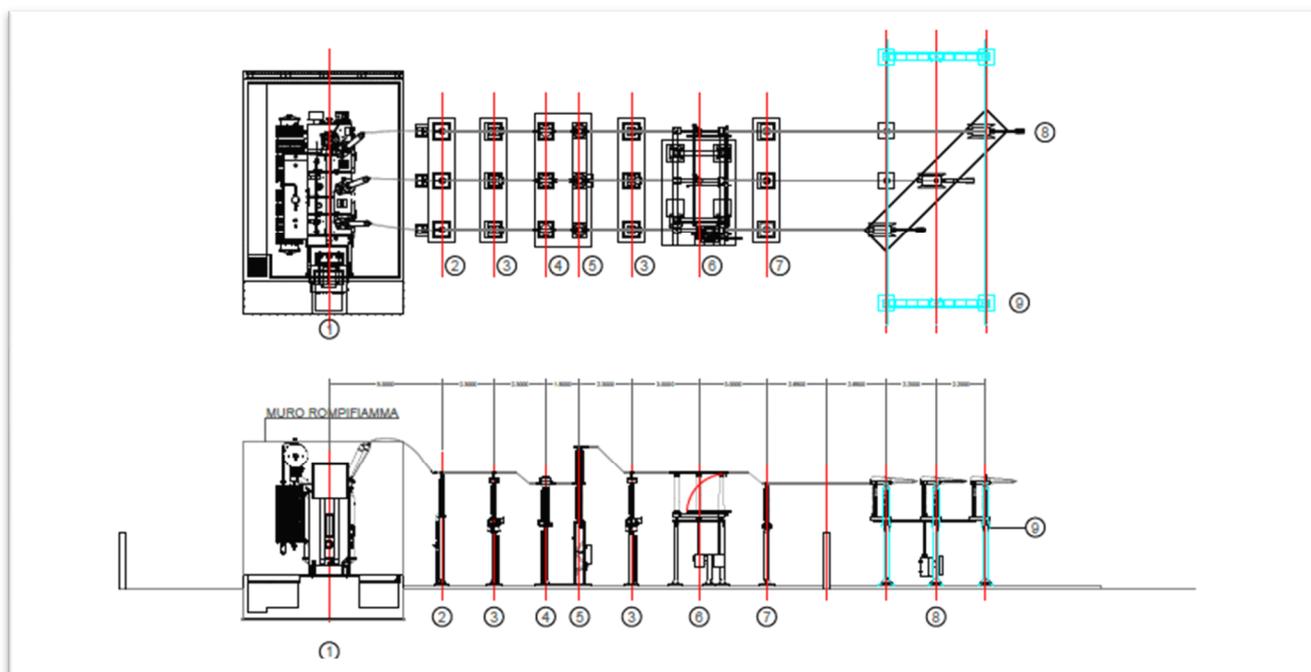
vista in pianta e vista laterale Stallo di Trasformazione MT/AT della Società Proponente
